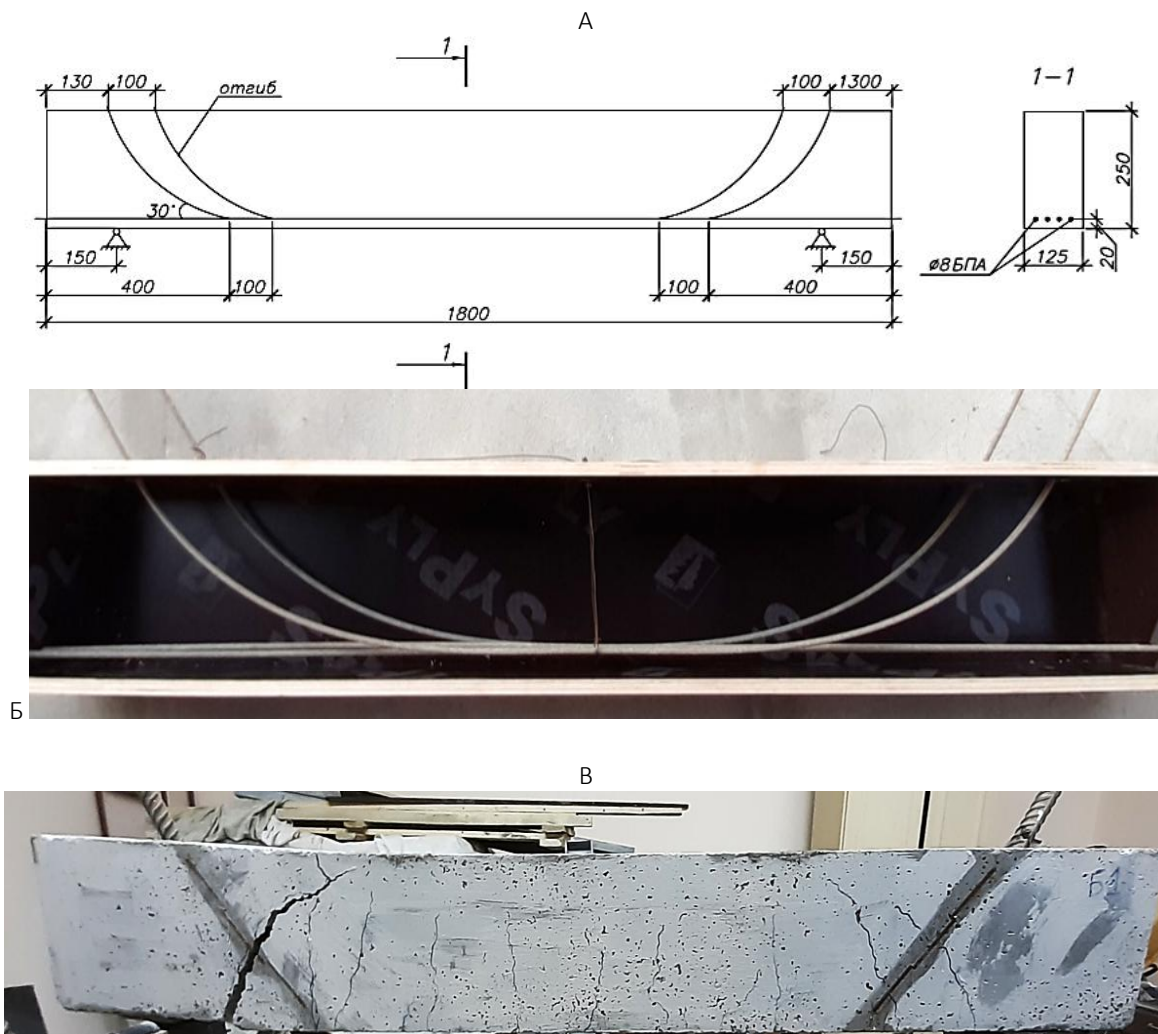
Экспериментальные исследования изгибаемых элементов с армированием стержневой базальтопластиковой арматурой; а – схема армирования, б – опалубка для изготовления образцов, в – схема разрушения образца
